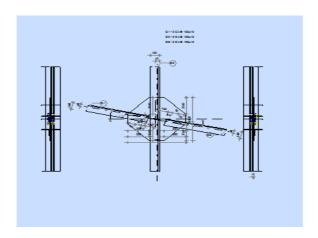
assemblage de palé de stabilité intermédiaire.
